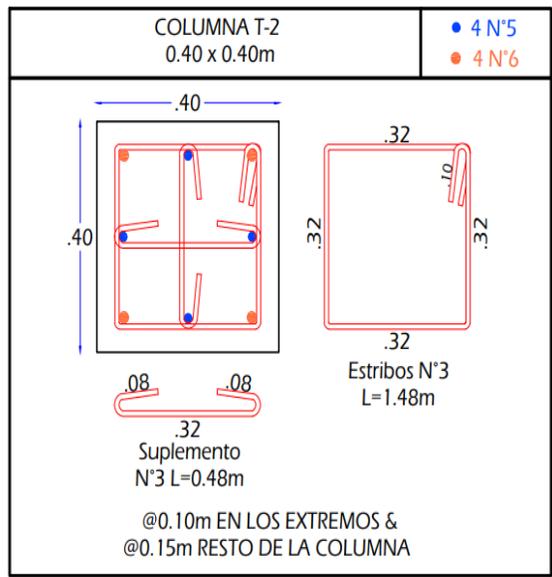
Despiece transversal y longitudinal de columna T2 plano Wiedii
